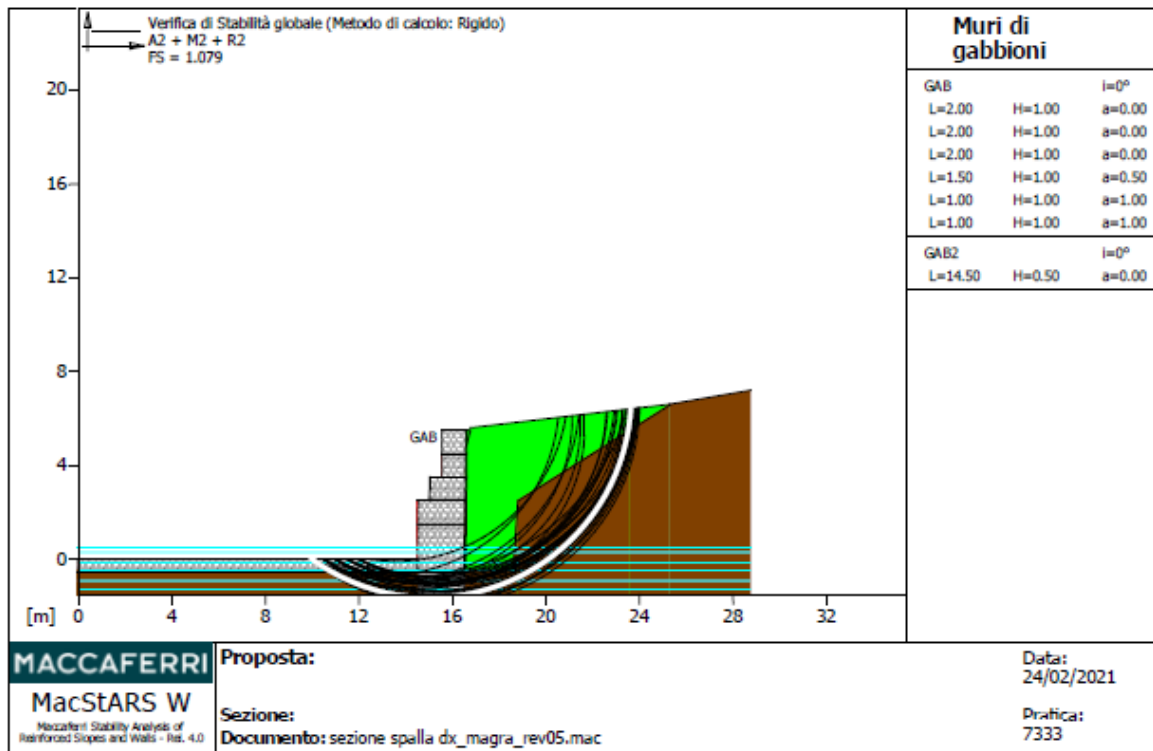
Verifica di stabilità globale sezione spalla dx- condizione di magra-statica
